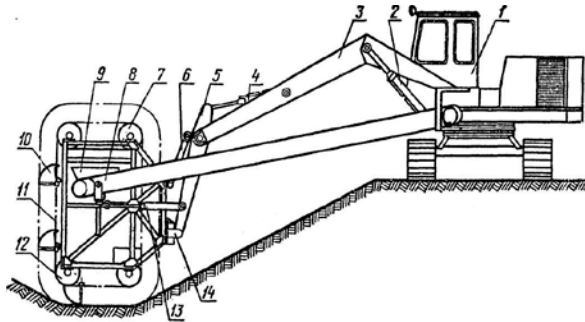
Многоковшовый рабочий орган к экскаватору с гидравлическим приводом рабочего оборудования: 1 – экскаватор; 2 – гидроцилиндры; 3 – стрела; 4 – гидроцилиндр; 5 – рукоять; 6 – гидроцилиндр; 7 – ведущий вал; 8 – транспортер; 9 – приемный бункер; 10 – ковши; 11 – ковшовая цепь; 12 – направляющие ролики; 13 – гидроцилиндр; 14 – двухплоскостный шарнир
